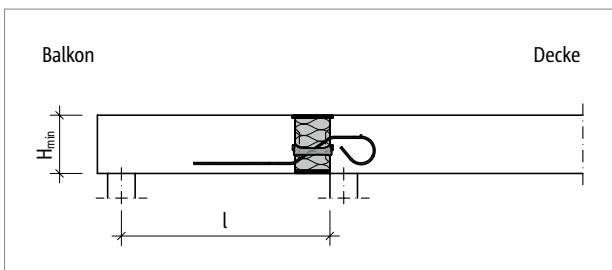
Schöck Isokorb® XT Typ QL: Statisches System (XT Typ QL-V1 bis V4)
